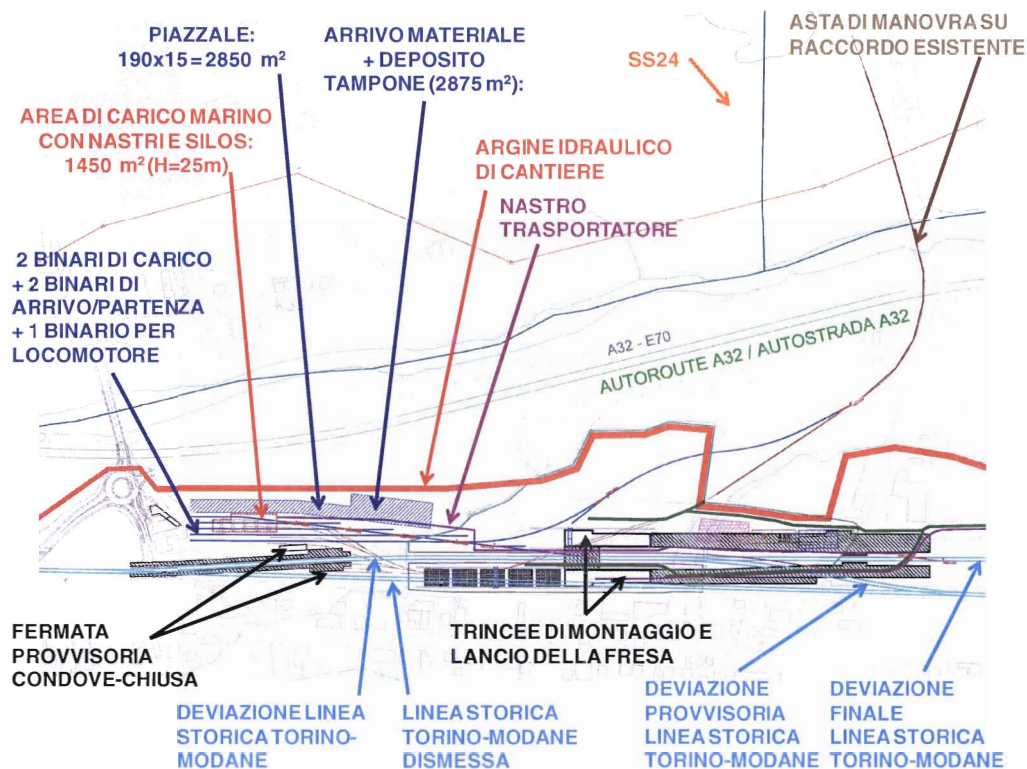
Area di carico di Piana delle Chiuse: stralci planimetrico
